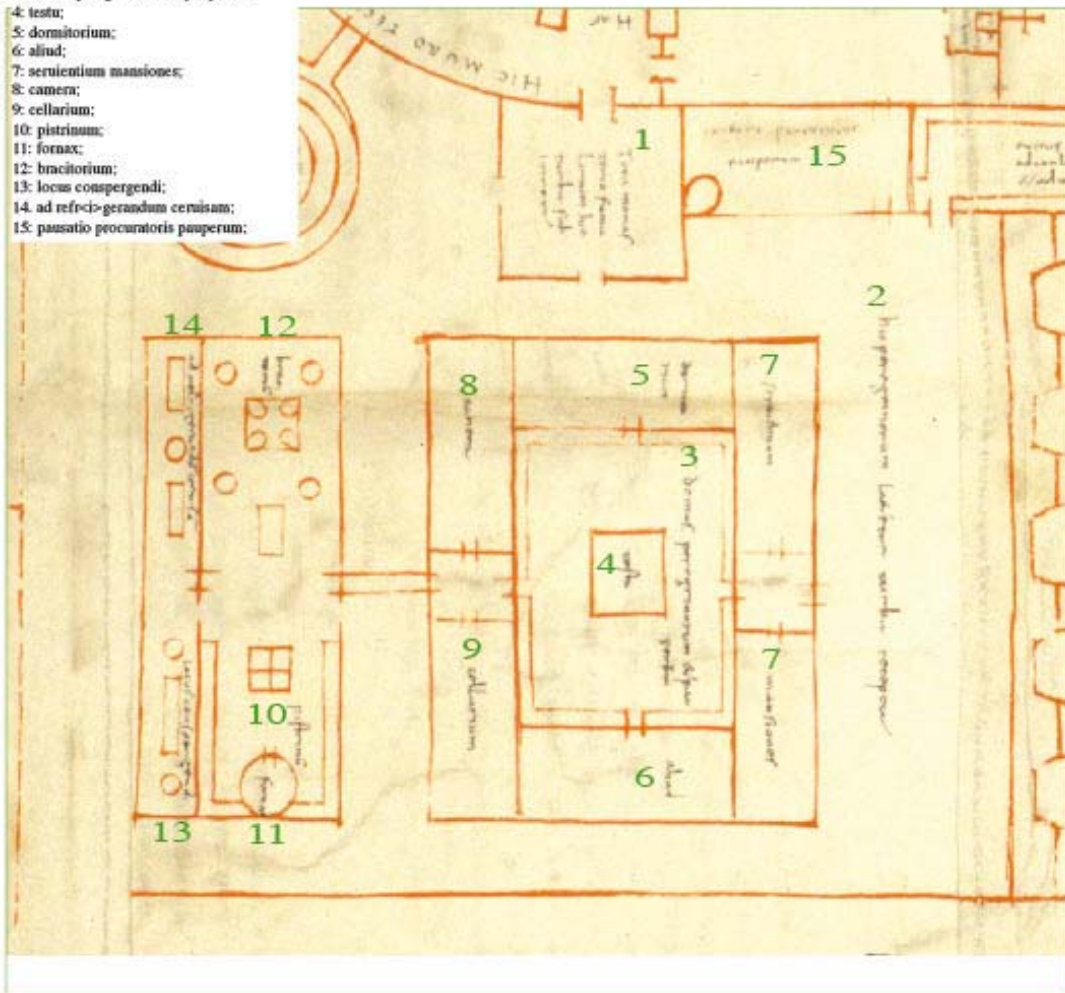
Klosterplan, Planausschnitt Pilger-/Armenhospiz, Armenpfleger und südl. Torhaus
